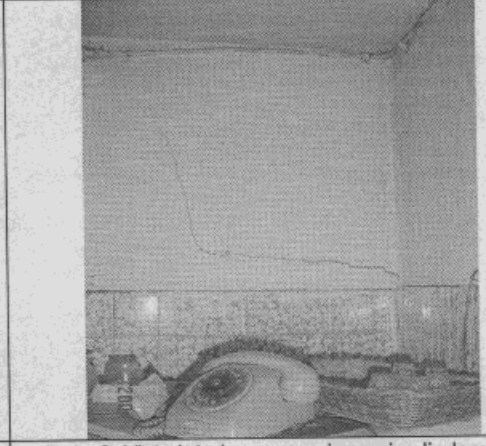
Vista interior muro primer piso lindero del costado sur (muro posterior). Se aprecia agrietamiento leve.
